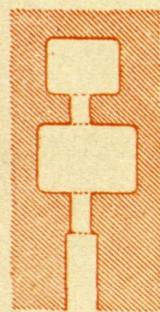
PLANTA DE UNA FOSA CAVADA EN LA ROCA CON UNA SEGUNDA CÁMARA.
